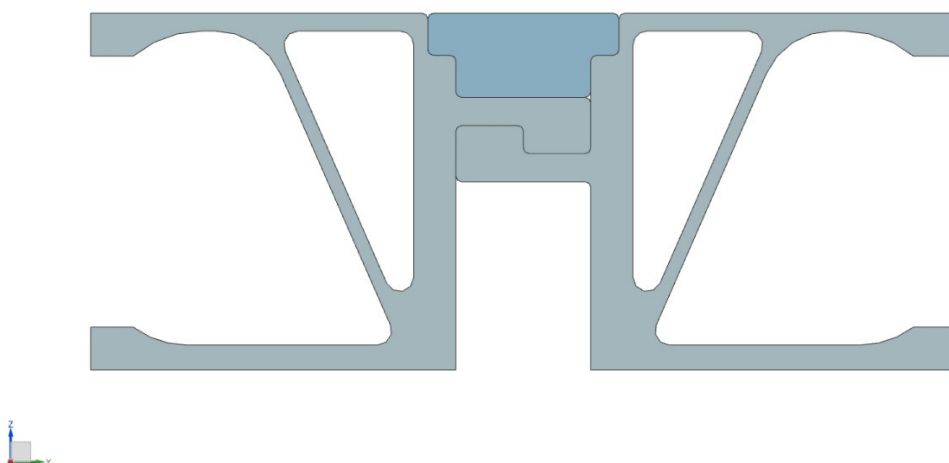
Proposition d'assemblage des panneaux de tablier tout aluminium au chantier
